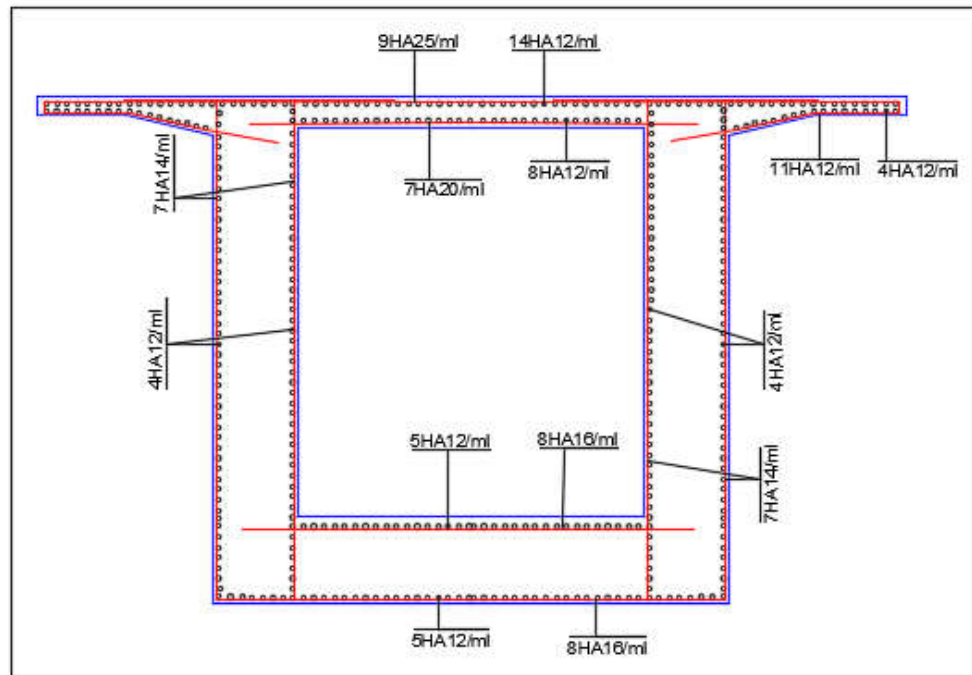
Schéma de ferrailage du voussoir sur pile
